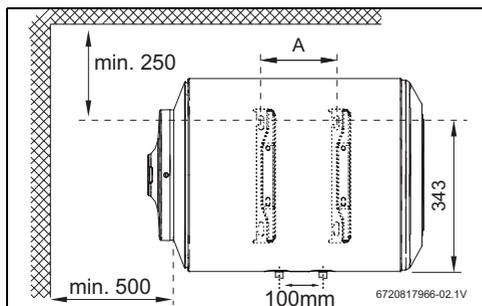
Dimensiones en mm (Montaje mural, instalación en posición horizontal)
